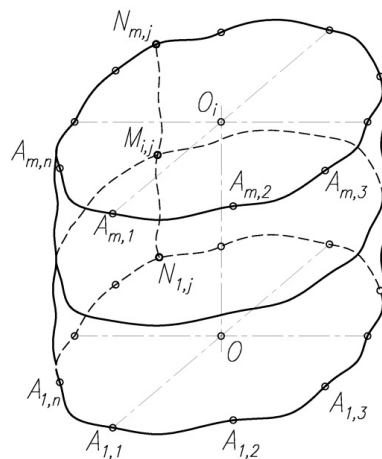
Геометрическая схема поверхности резервуара с несовершенствами
